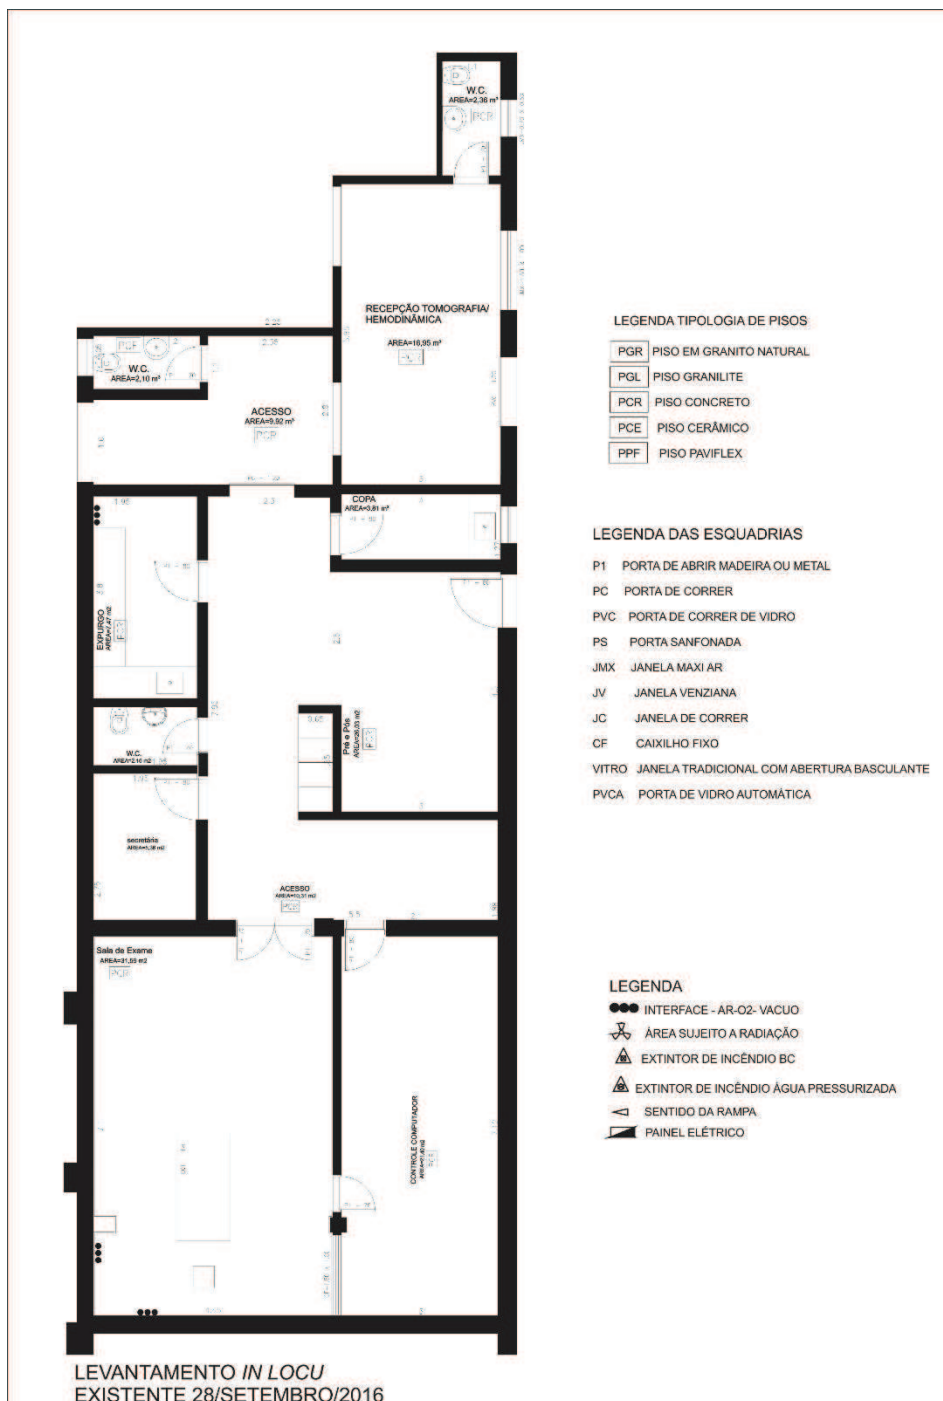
Planta do levantamento *in locu*. Situação encontrada em 28 de setembro de 2016.
